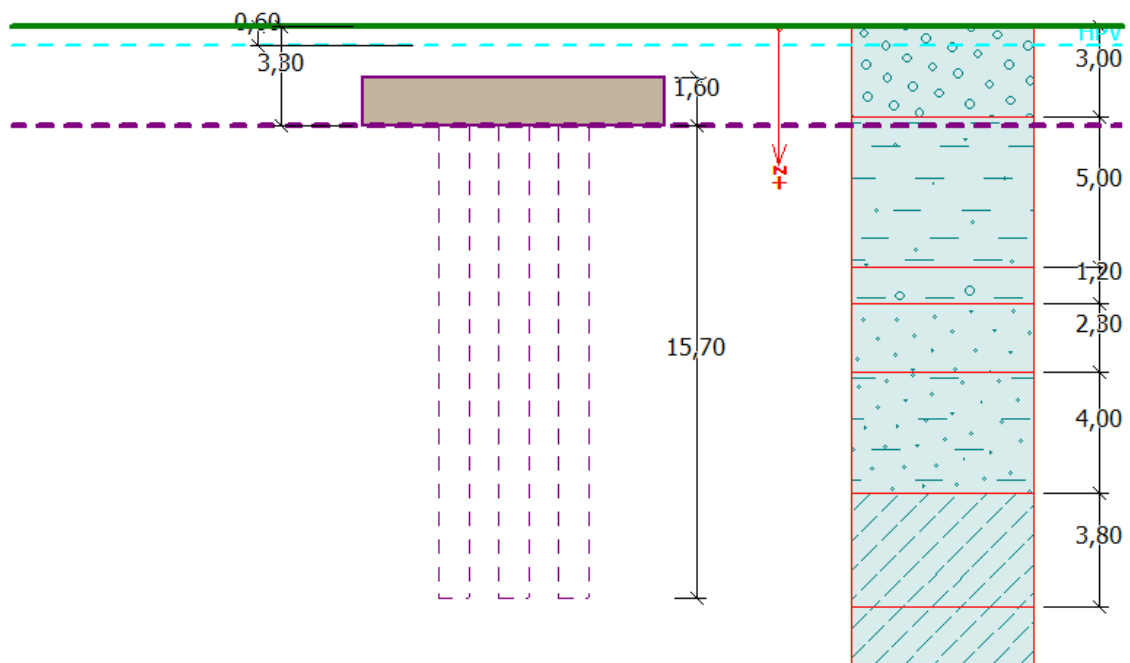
Statický model v programu GEO 5 pro piloty průměru 1200 mm
